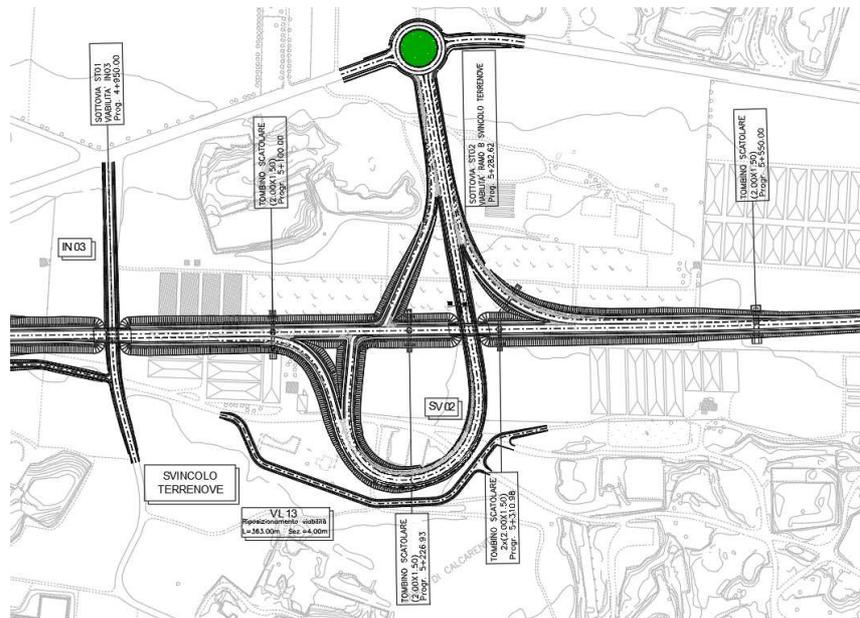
Planimetria dello svincolo di Terrenove e rotonda
